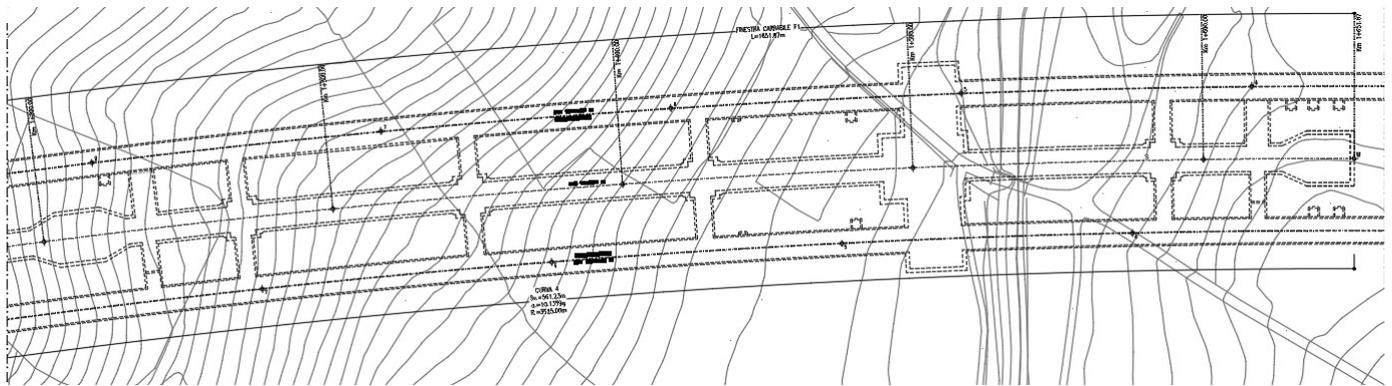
planimetria zona area di sicurezza della Finestra F1
